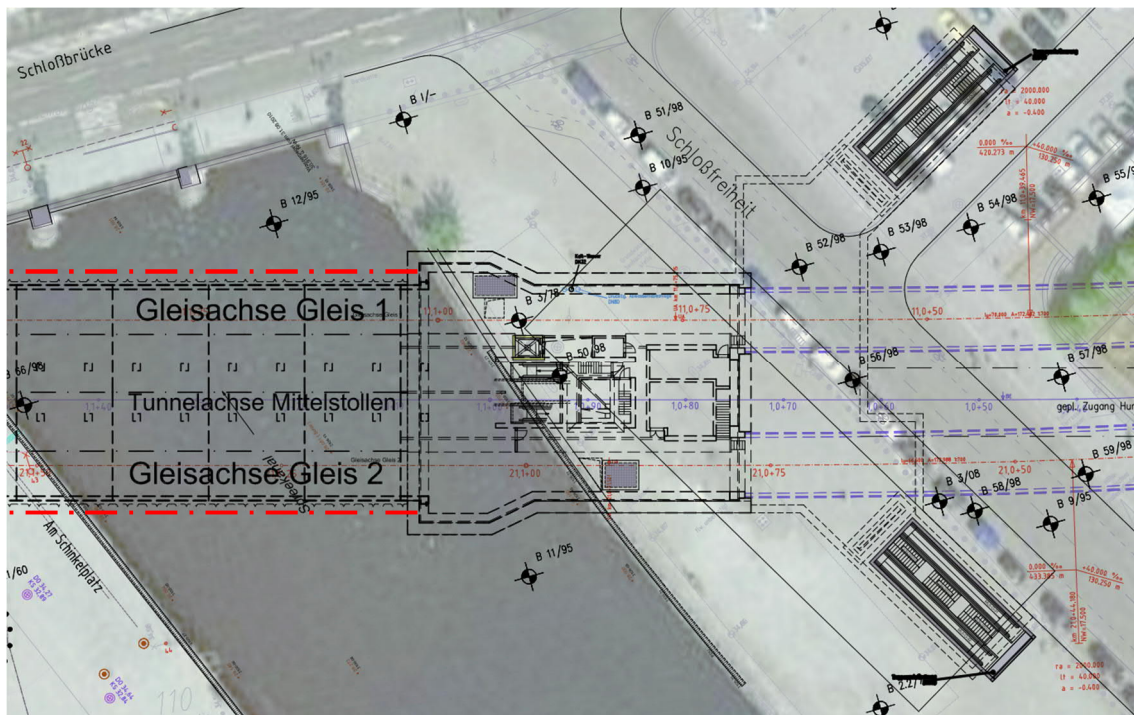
Grundriss Schachtbauwerk Ost Station Museumsinsel mit außen liegenden Bohrungen
